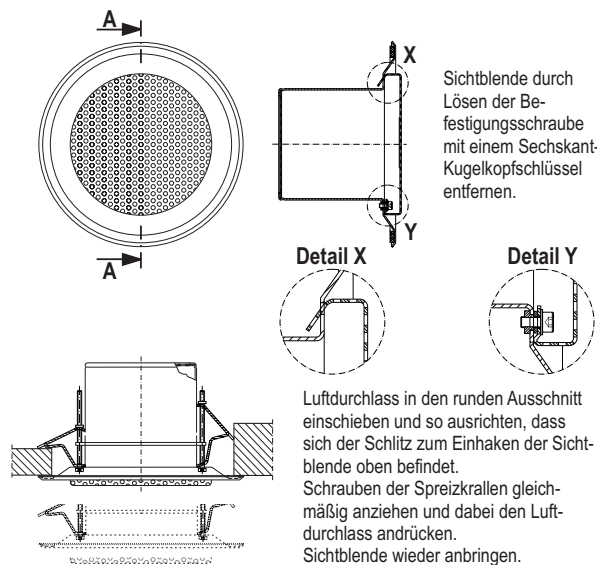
Montageskizze Runder Stufenquellauslass, dargestellt DN 80 (Einbau DN 100 erfolgt analog)
